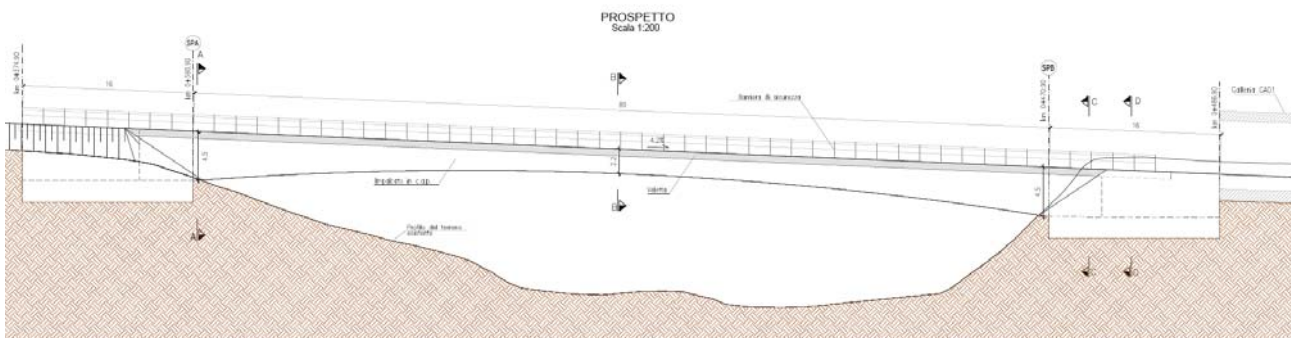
Prospetto Ponte Ru Sec nel Progetto Definitivo
